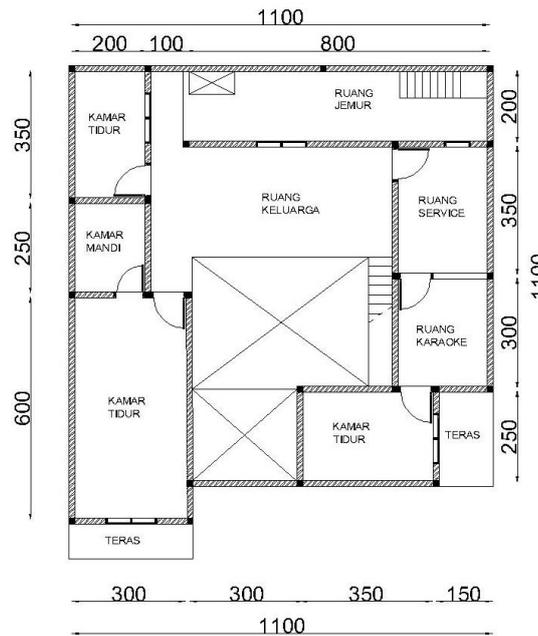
11 Denah Rumah *Sample 1* Dulu
